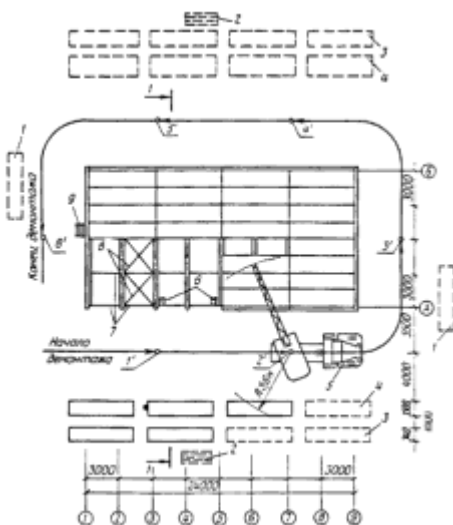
Схемы демонтажа плит покрытия и стеновых панелей
